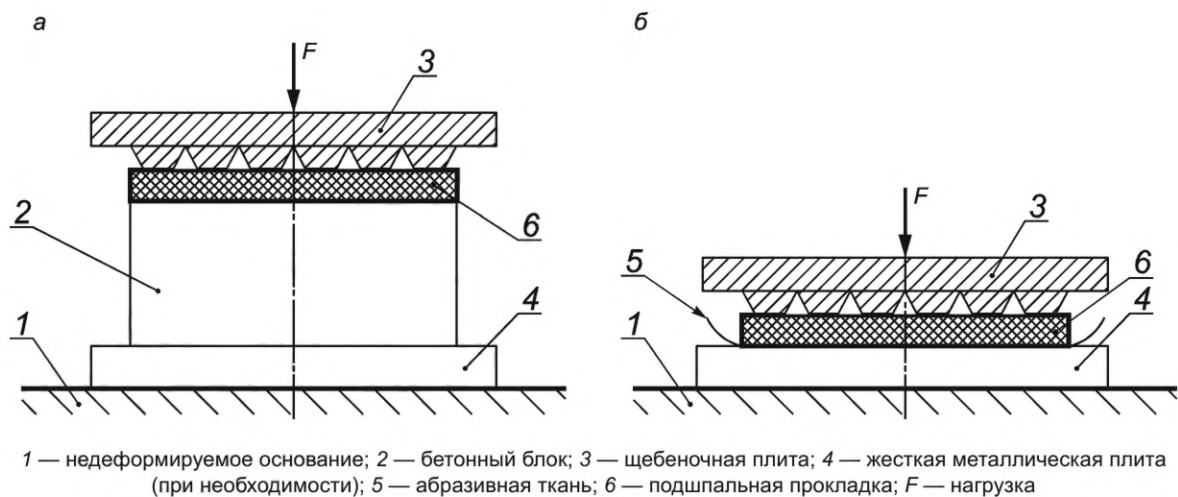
Схемы проведения испытаний для образцов, скрепленных с бетонным блоком (а) и для образцов без бетонного блока (б)
